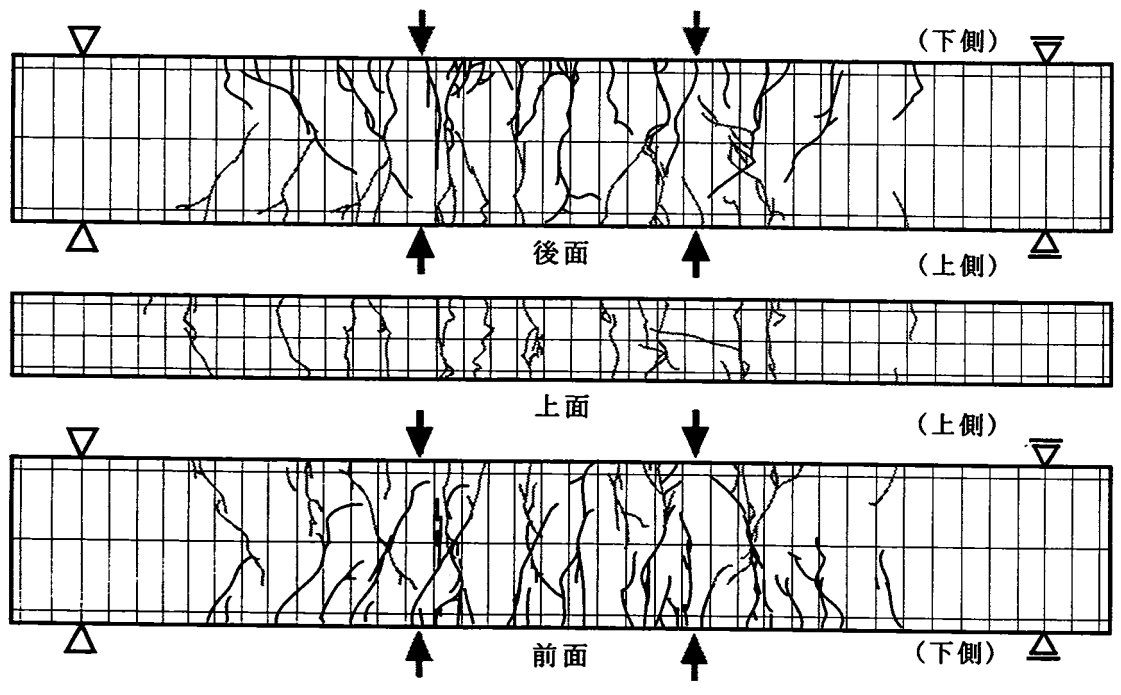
f) ひび割れ性状 [BS-2 ; R = 1/50rad.]
